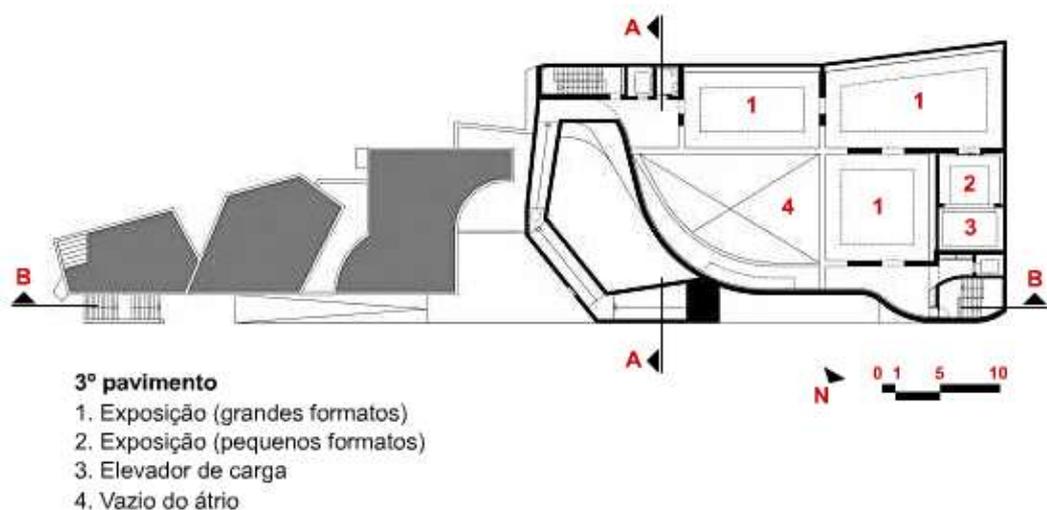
Planta baixa do 3º pavimento (Fonte: ARCOWEB, 2011)
